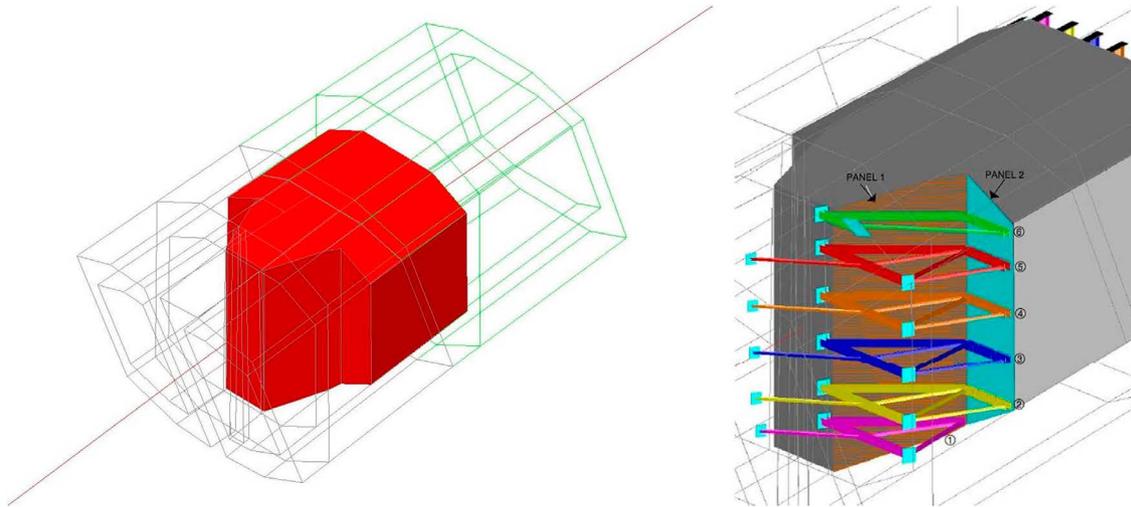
Modelo 3D del diafragma de las pilastras 8 y 13 y vista 3D del encofrado empleado.
